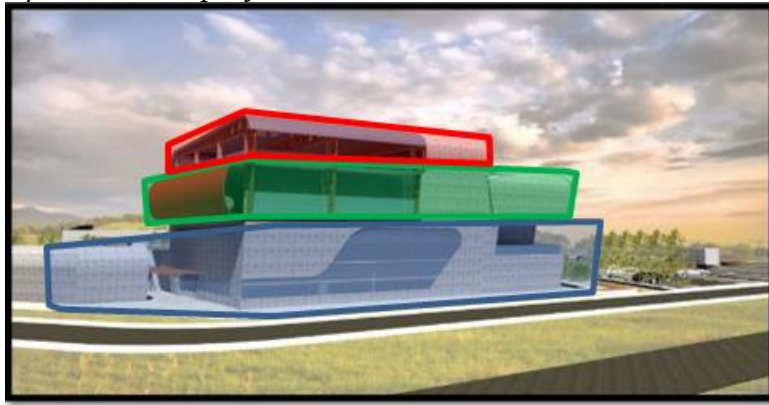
Estructura y Detalle constructivo propuestos en el proyecto Analizado.
